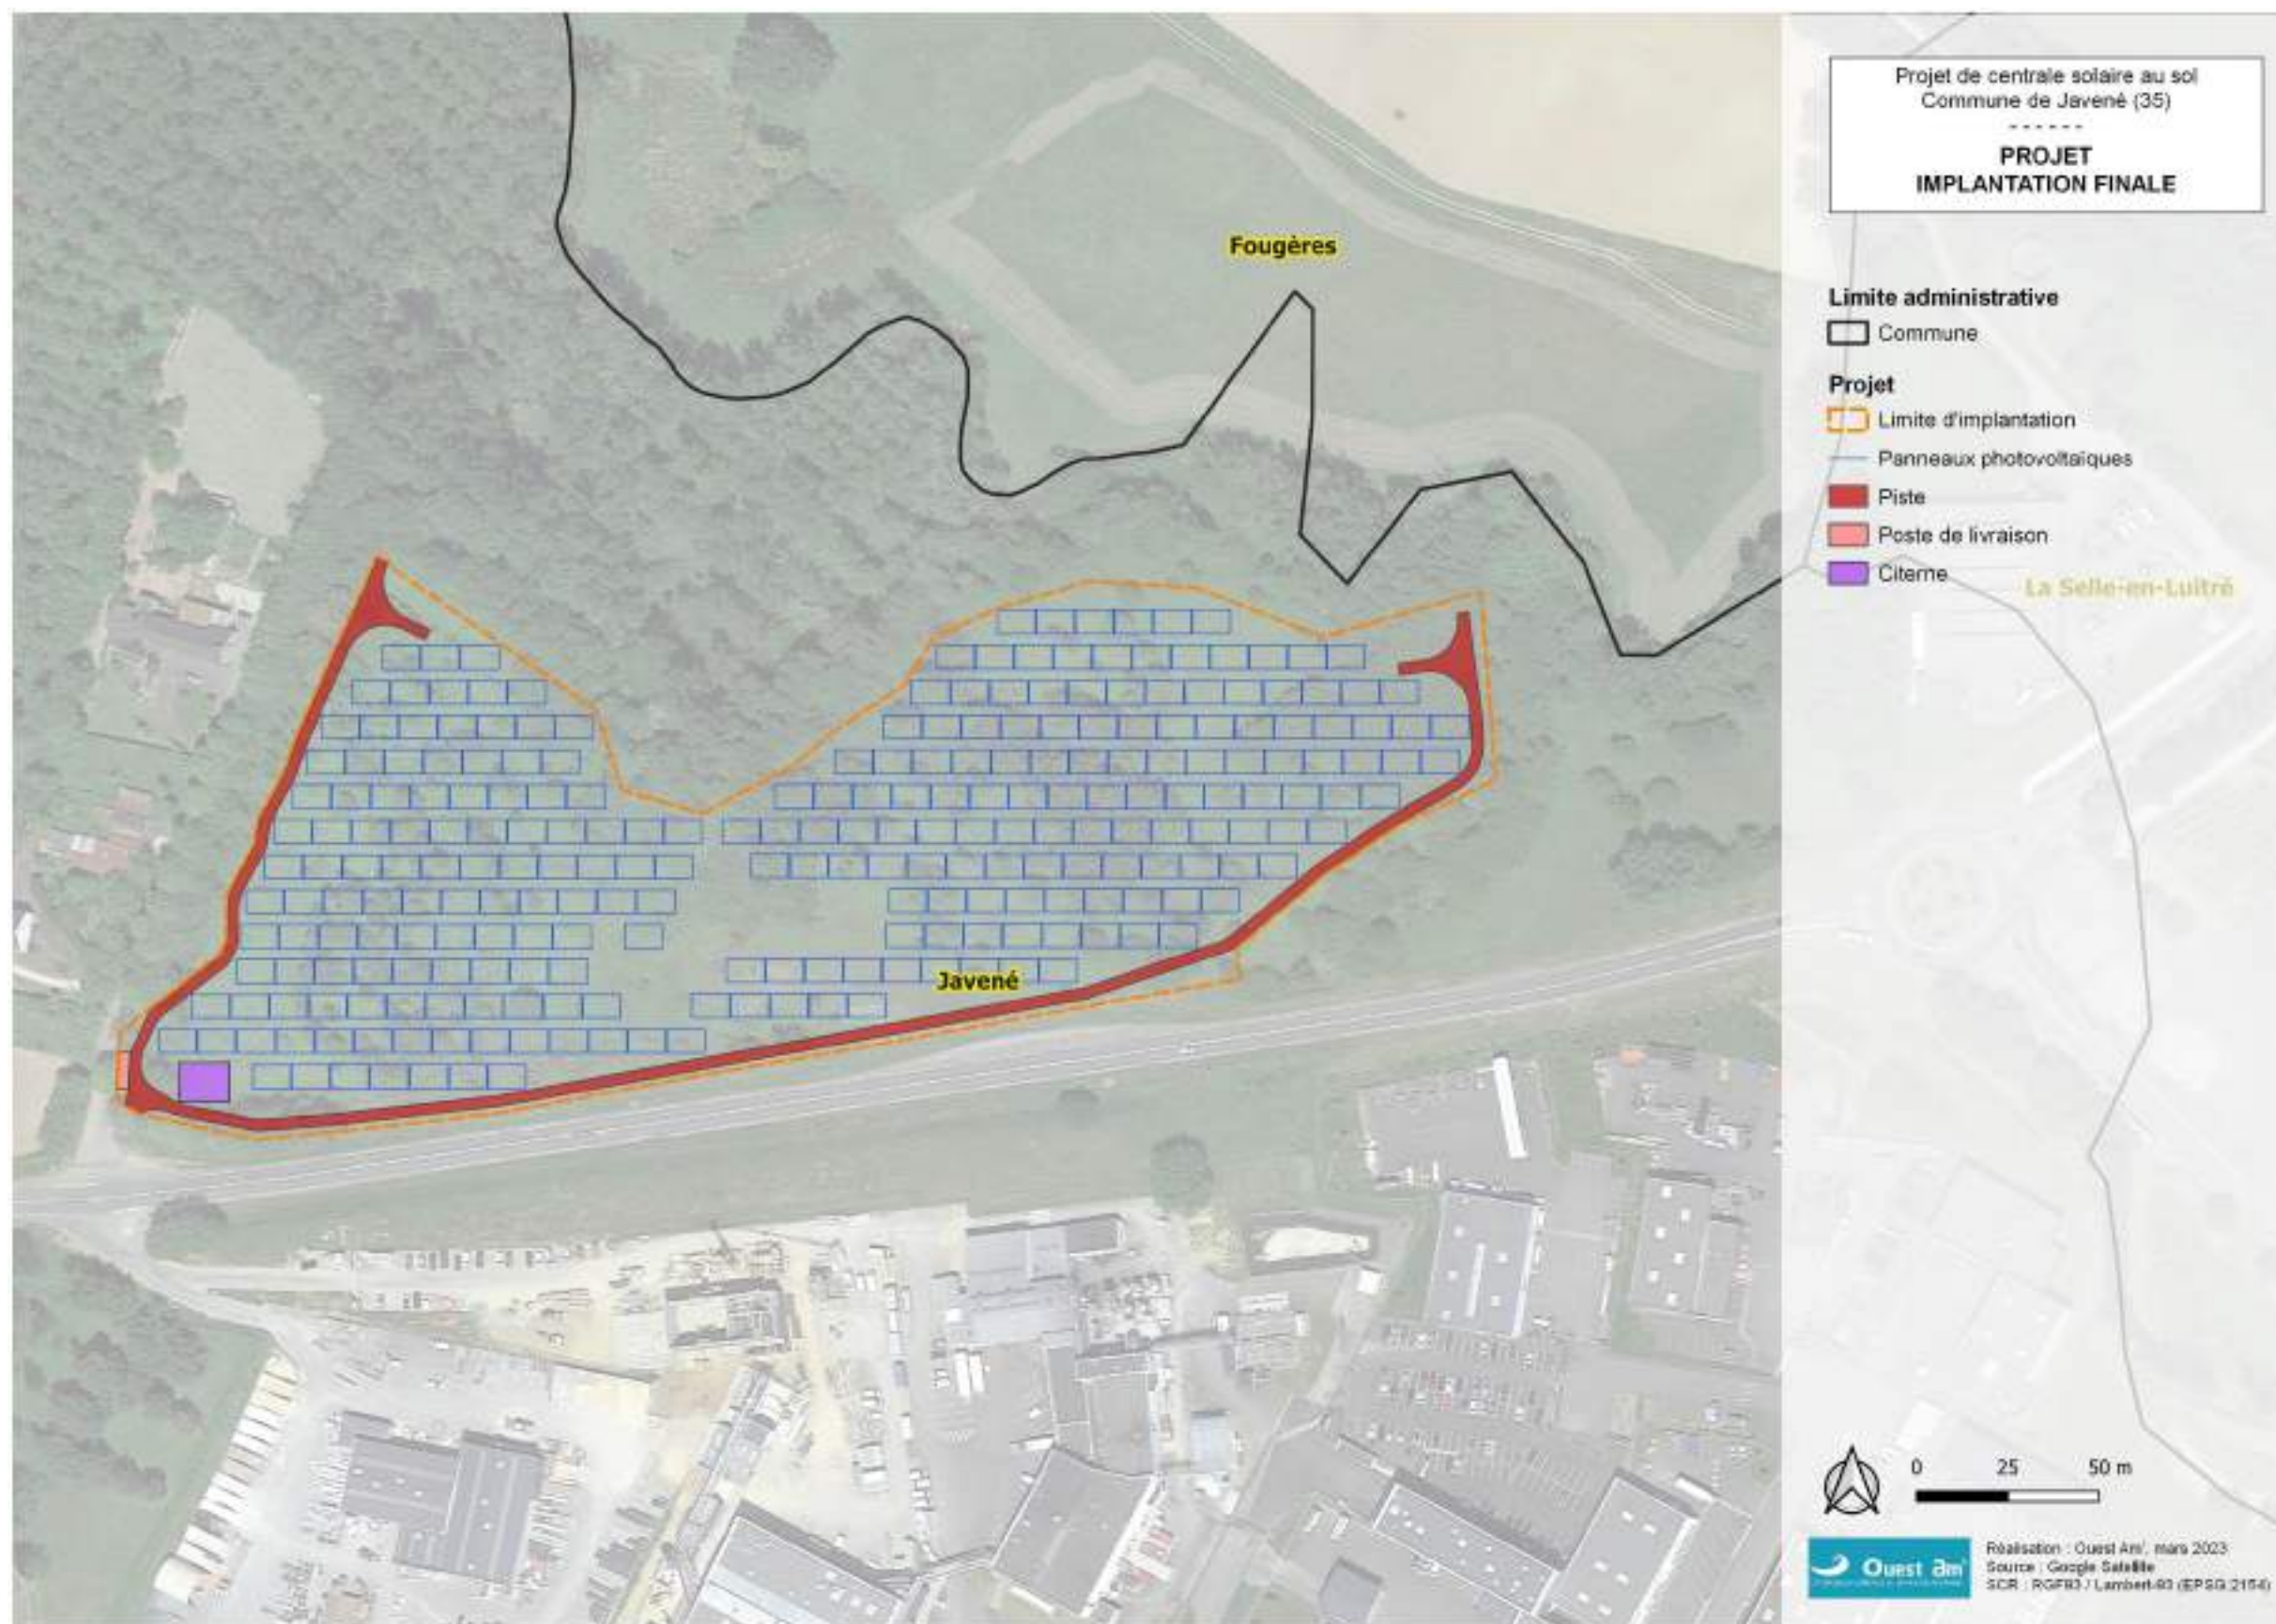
Plan d'implantation du projet photovoltaïque (Source : Javené Solaire)
